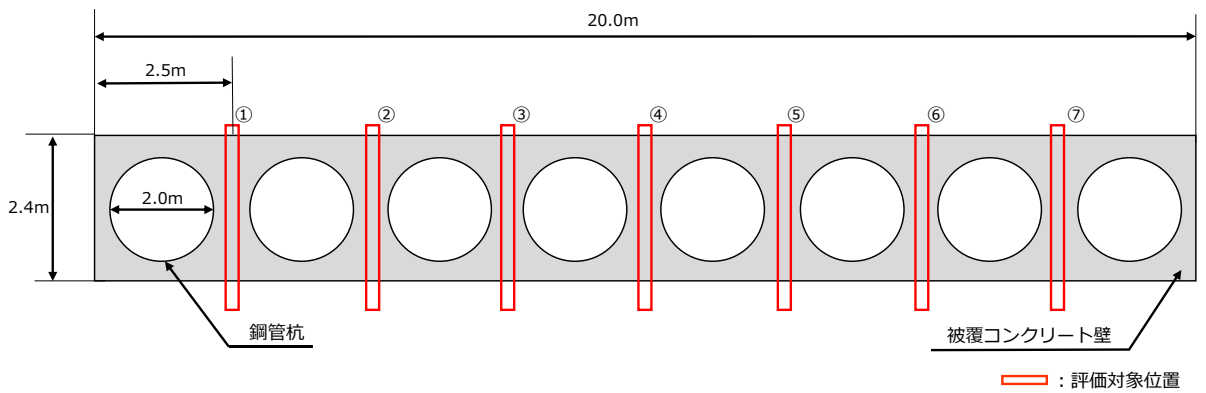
(2) 評価対象位置図 (③-③断面 平面図)
